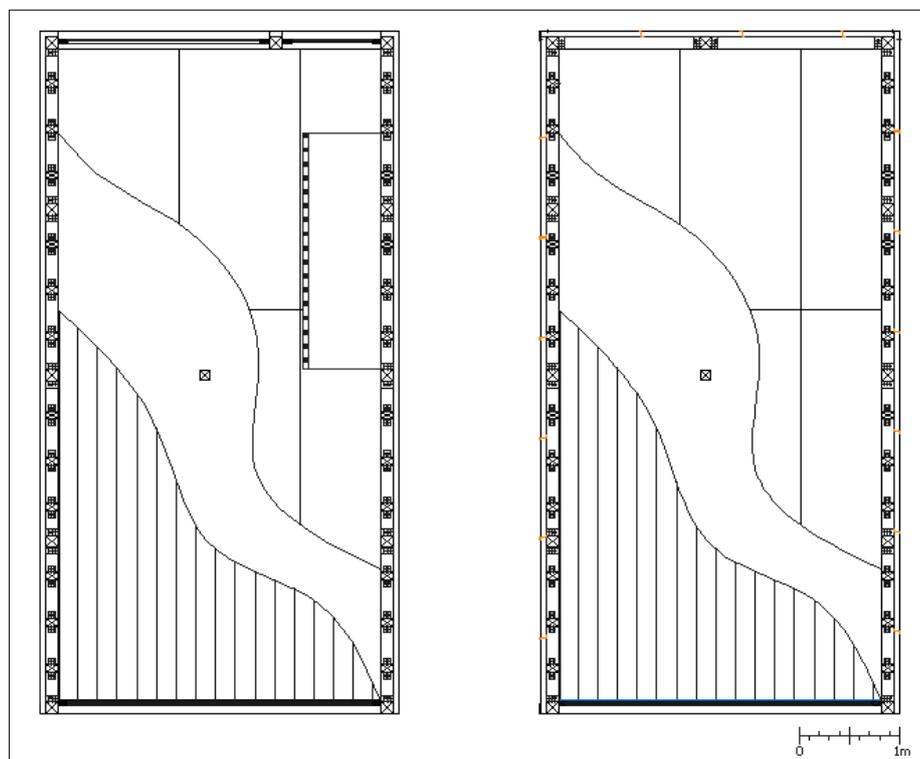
Planta de pavimento da habitação base (tipologia 1). Esquerda (cota +3.20) e direita (piso térreo)
